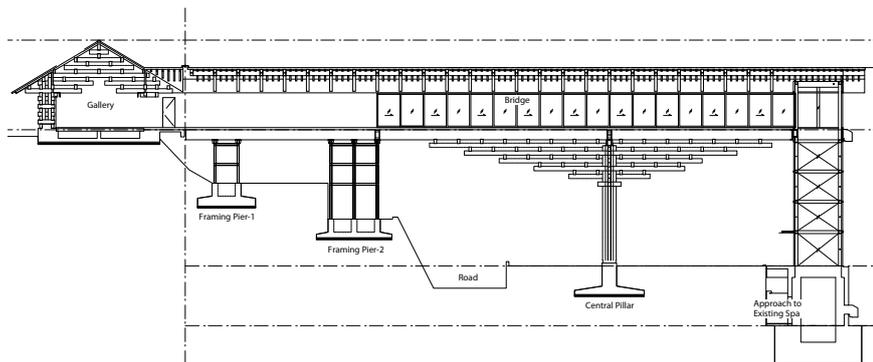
Sección longitudinal del Museo Y Puente de Madera
